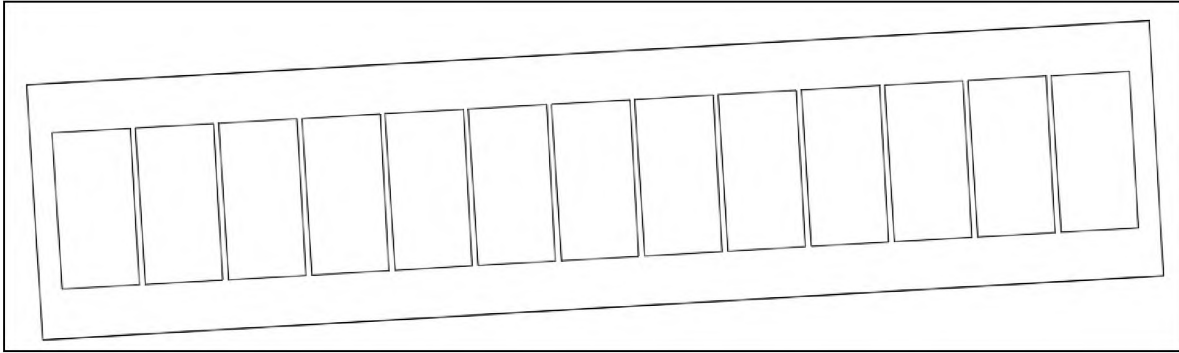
Distribución de paneles solares.* Fuente: Grupo de investigación.
